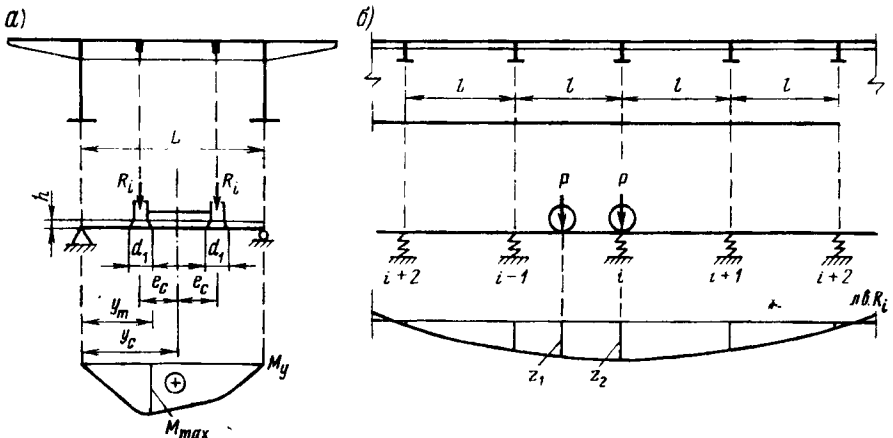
Схемы к расчету поперечных балок ортотропной плиты
